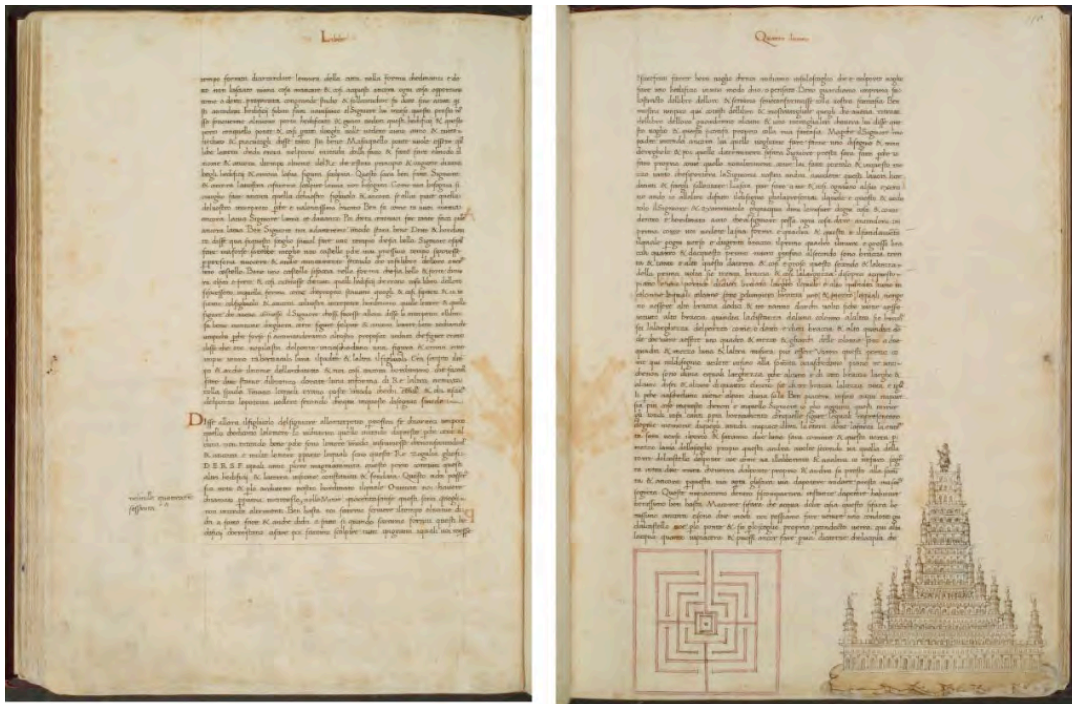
O “arranha-céu” de Filarete e sua planta em forma de labirinto. Antonio Averlino detto Filarete, *Trattato dell'architettura*, ms., sec. XV, membr., mm 398 x 280 (Firenze, BNCF, Fondo Nazionale II.I.140). Fonte: *The Internet Archive*. Disponível em: <<https://archive.org/details/mss.-ii.-i.-140-images/page/n237/mode/2up>>. Acesso em: mar. 2022.
